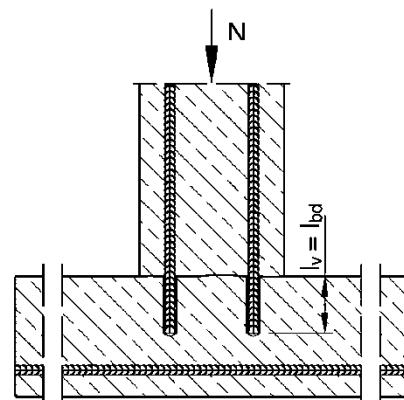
Bewehrungsanschlüsse überwiegend auf Druck beanspruchter Bauteile
